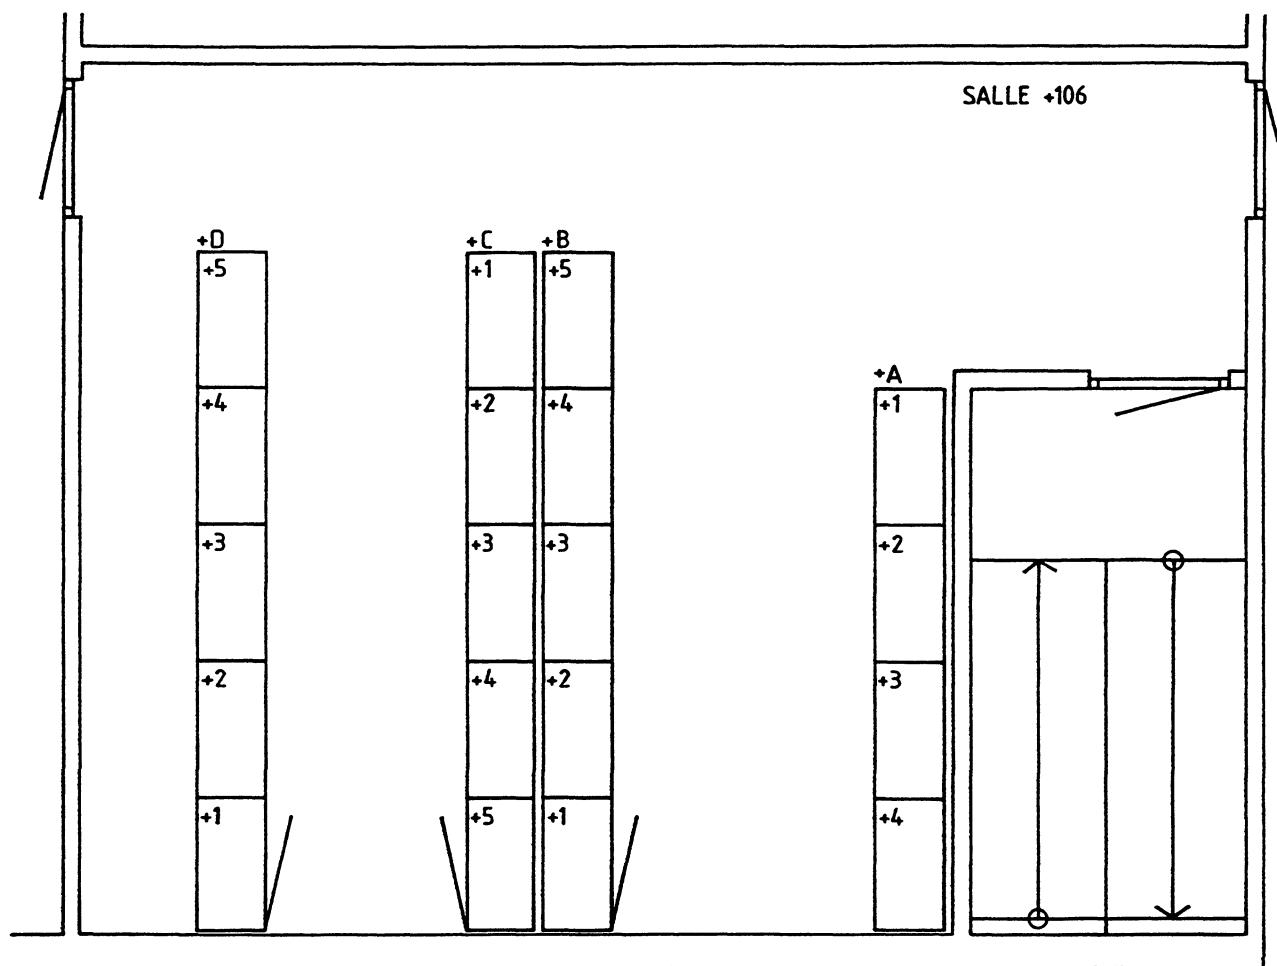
Exemple de plan d'installation; salle de commutation avec ensembles d'appareillage.
